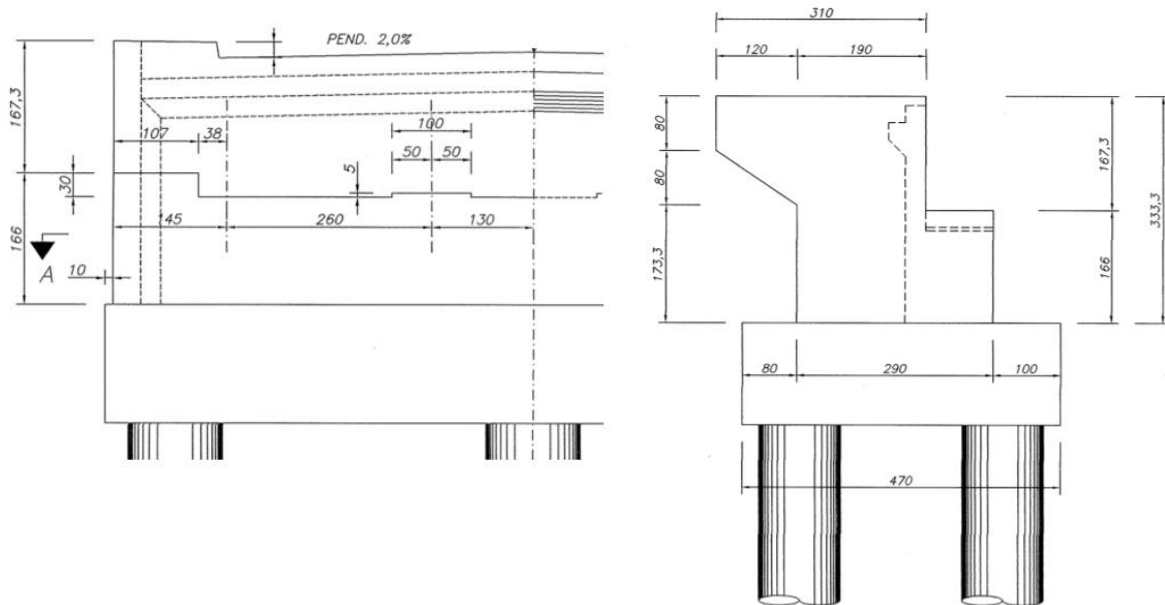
Elevación y corte longitudinal de estribos de Puente Águila Norte. Planos Puente MOP [41].
